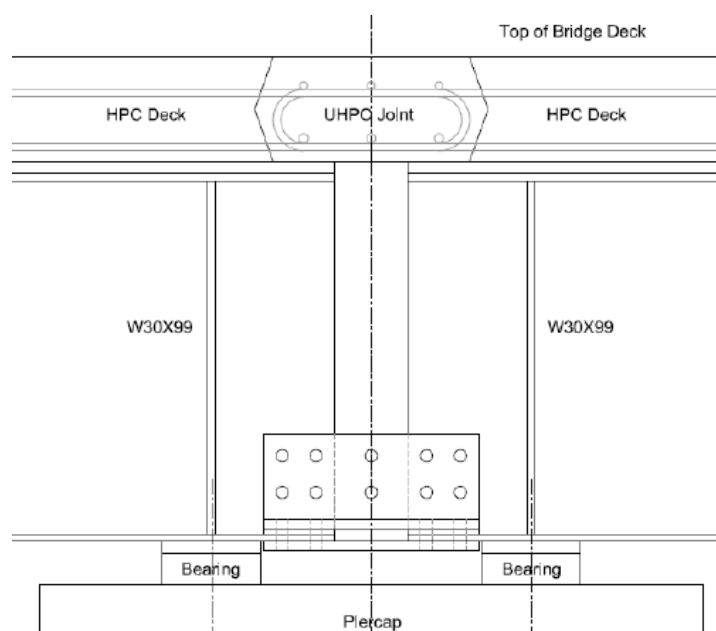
Joint transversal au-dessus d'une pile (Hartwell, 2011)
